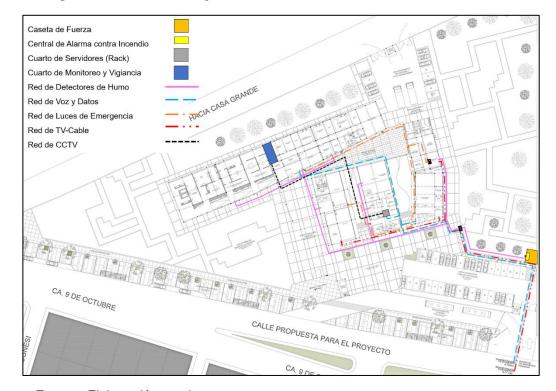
Planteamiento general de las conexiones de cableado estructurado.
